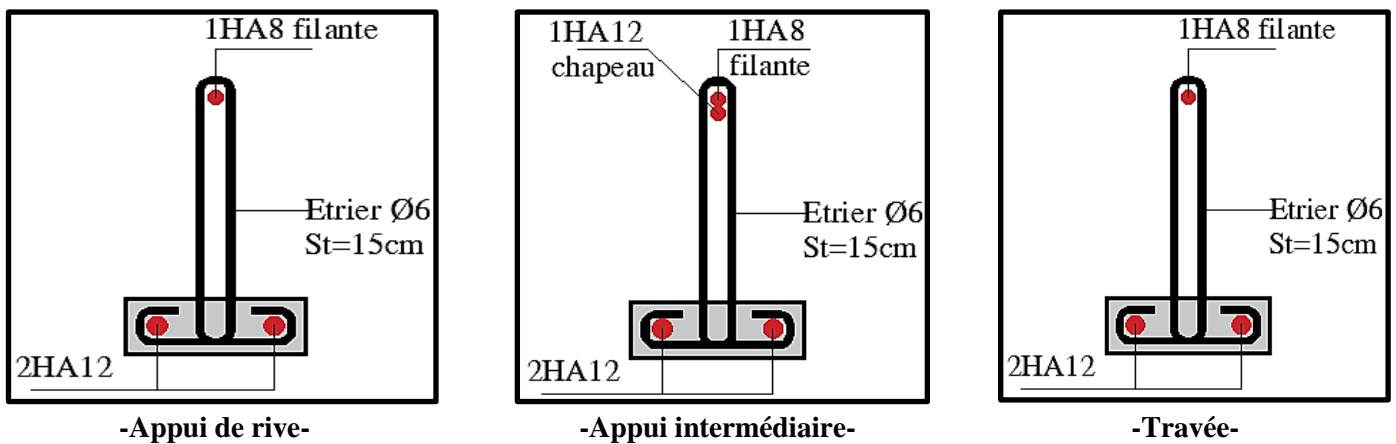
Ferrailages des poutrelles (terrasse inaccessible).
